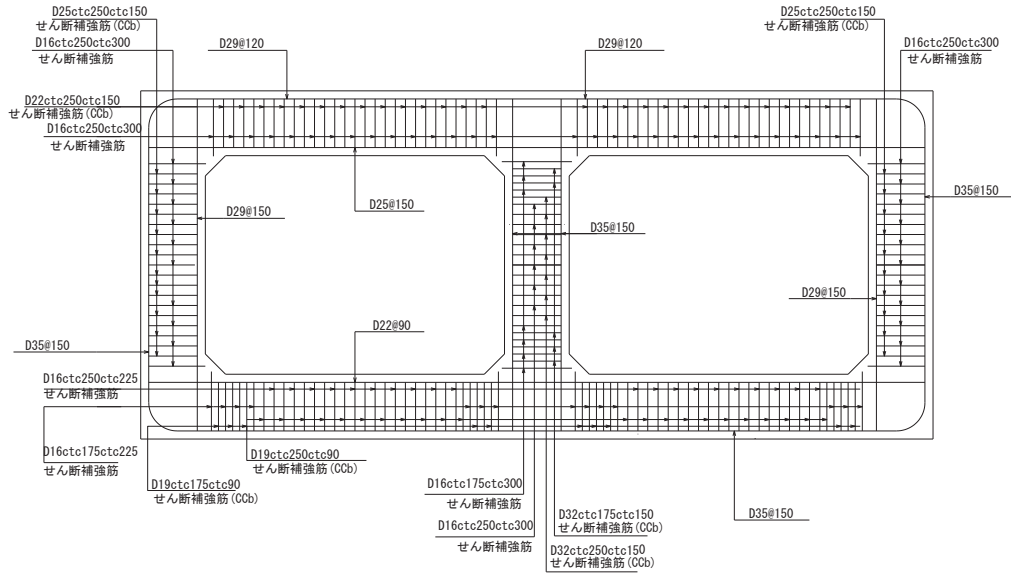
(1) 第 1 号機取水路の概略配筋図 (A-A 断面)
